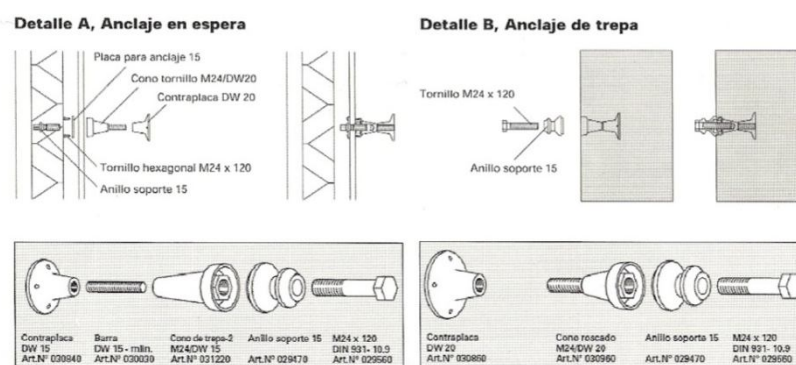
Ancoragens de trepagem (Peri, 2008)
